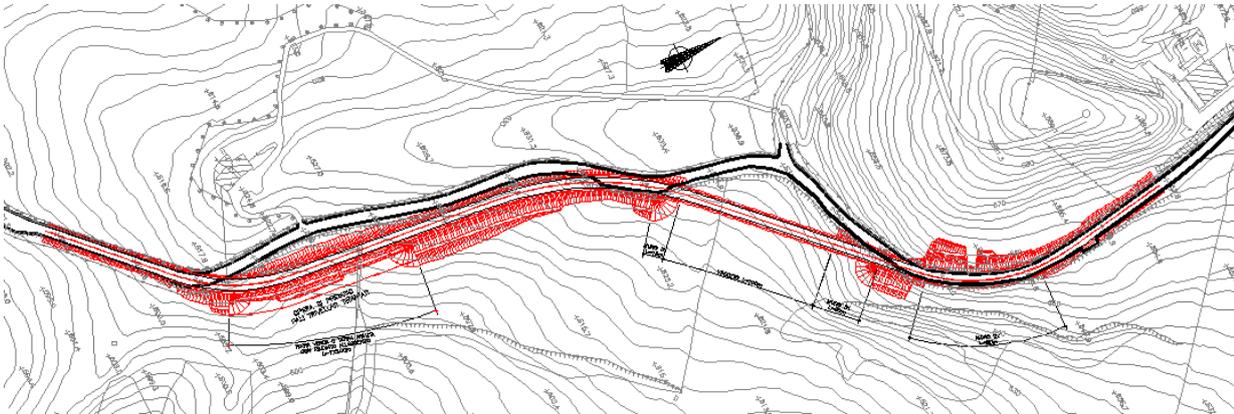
Stralcio planimetrico riqualifica SR65 della Futa nel tratto "Scale della Futa"
